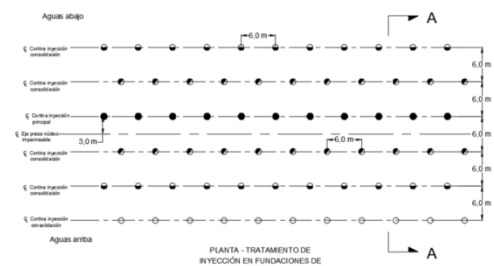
Planta de inyecciones de consolidación en tratamientos de fundación para presas. Adaptado de "Design Standards No. 13 Embankment Dams" de U.S. Department of the Interior Bureau of Reclamation. (2014).
